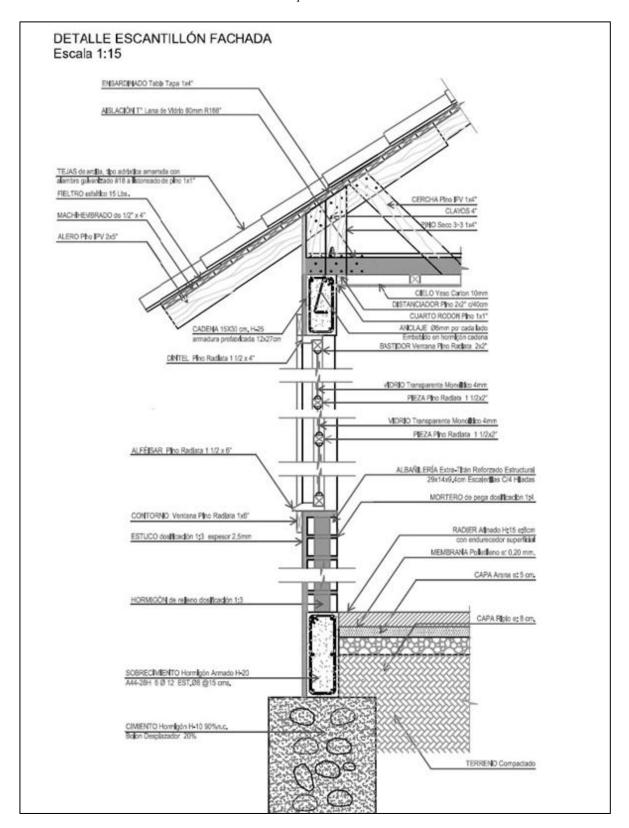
Modelo tipo de la vivienda nueva construida. Fuente: proyecto de reconstrucción Zócalo estudio de arquitectura.
